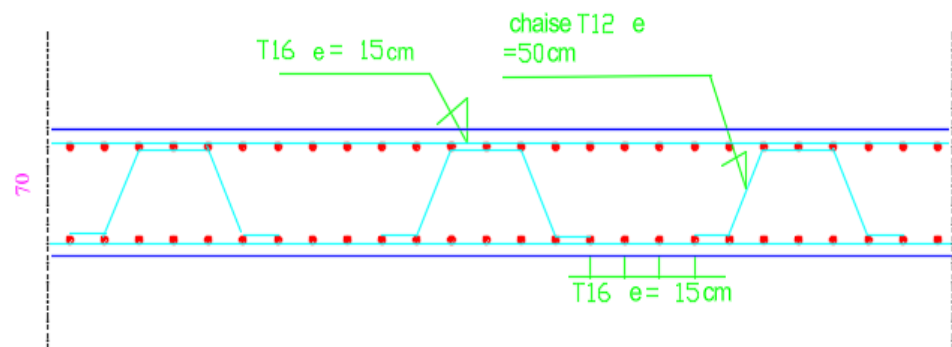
Ferrailage de la dalle du radier sur appui
